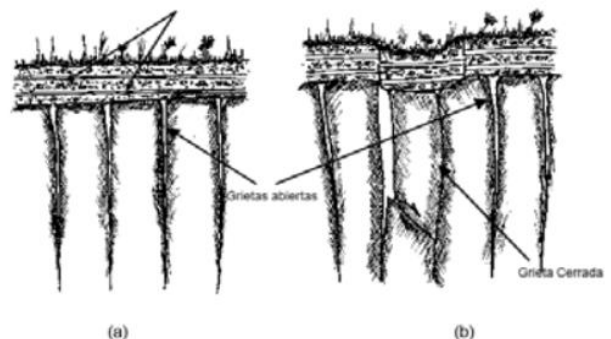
Mecanismos de agrietamiento. (a) Grietas verticales y (b) grietas verticales que fallan transversalmente afectando la subrasante del suelo [2].
